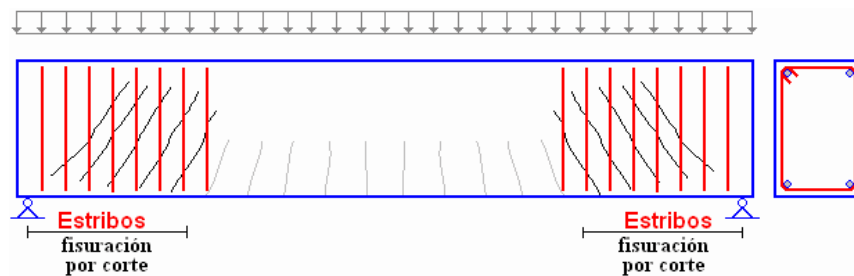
Armadura transversal que cose a las fisuras de cortante.
